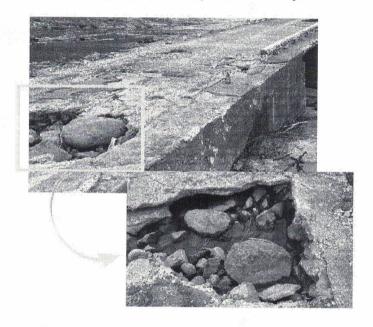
Fissuras Transversais da Laje de Aproximação L2
